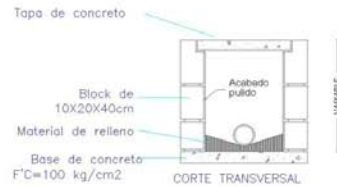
Plano de Redes Hidráulicas y Sanitarias
